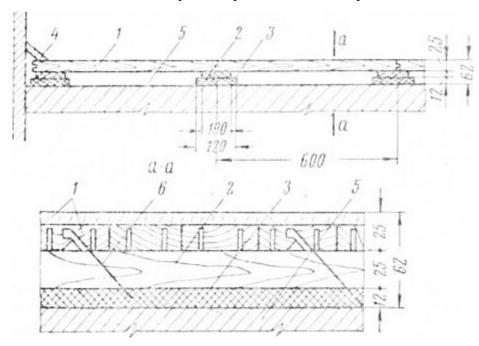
Конструкция пола из паркетных досок по лагам 1- паркетные доски; 2- лаги; 3- прокладки из древесноволокнистых плит; 4- галтель; 5- железобетонное перекрытие; 6- гвоздь
